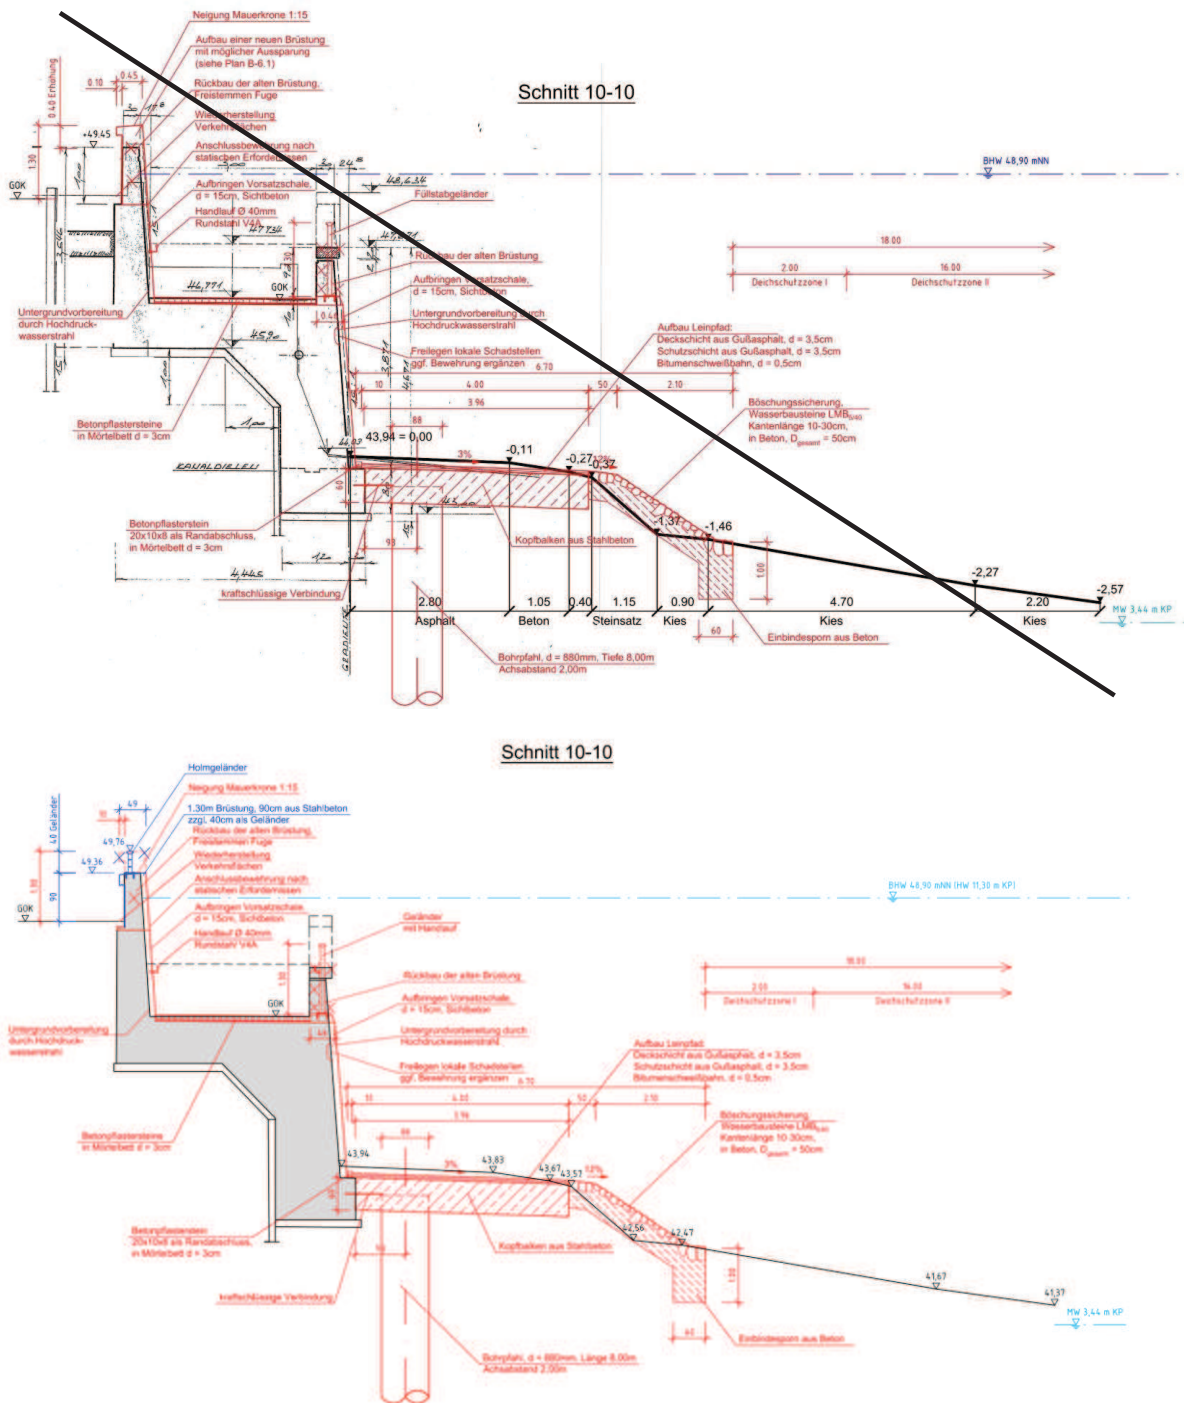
Detailausschnitt Sanierung Rampenbereich
